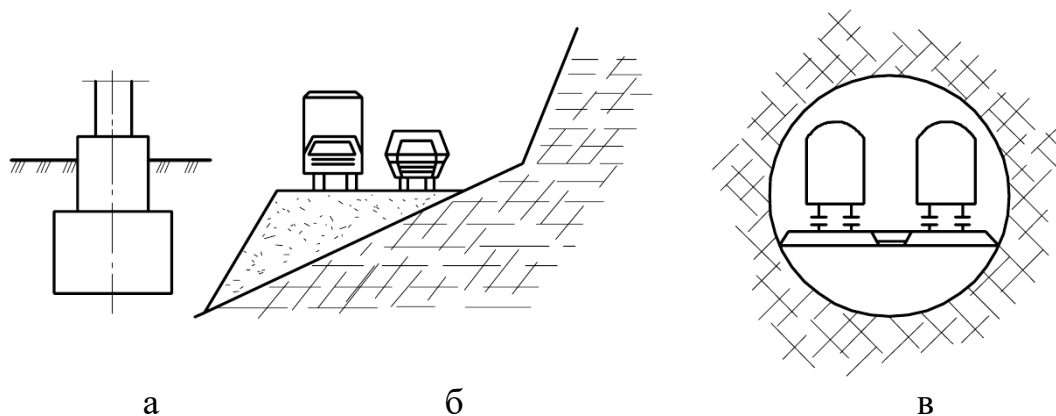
Використання ґрунту в будівельних цілях: а – фундамент будівлі; б – насип; в – підземна споруда
